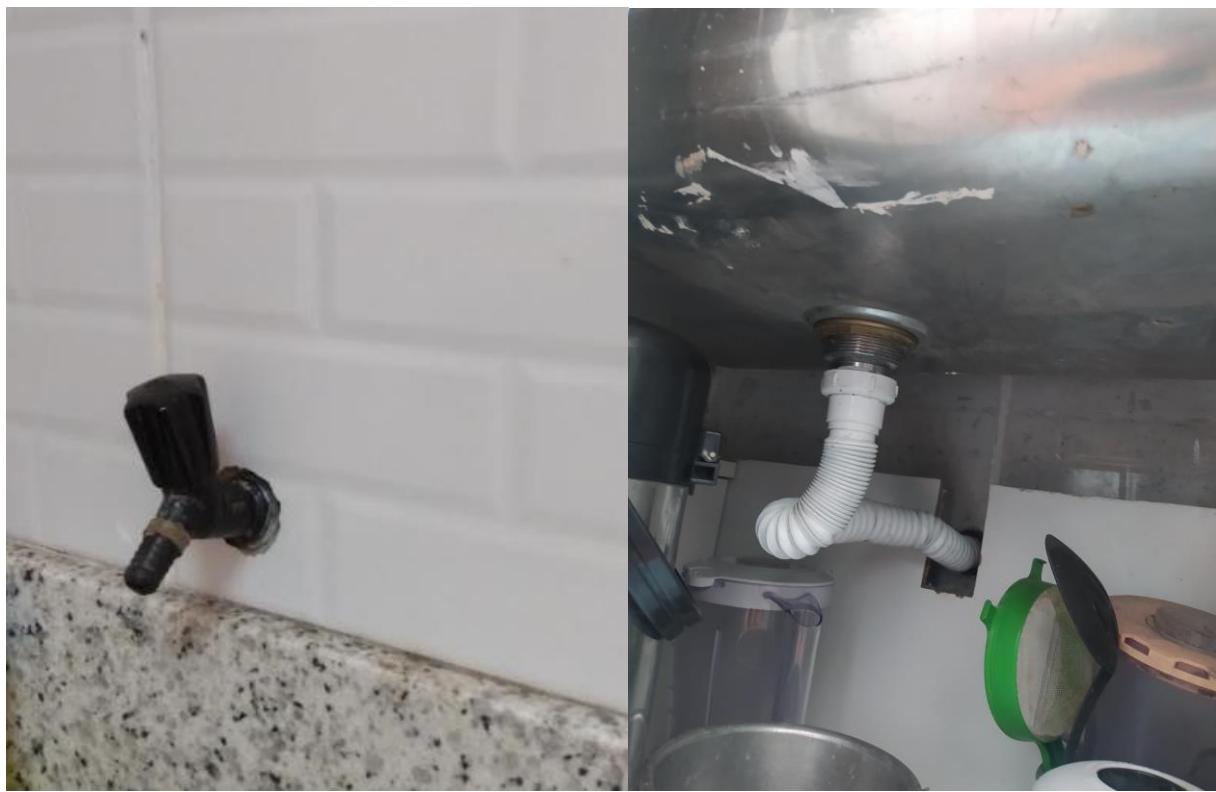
Foto XX: Visão detalhada – Torneira Pia - Refeitório Anexo II Foto XX: Visão detalhada - Sifão pia - Refeitório Anexo II
